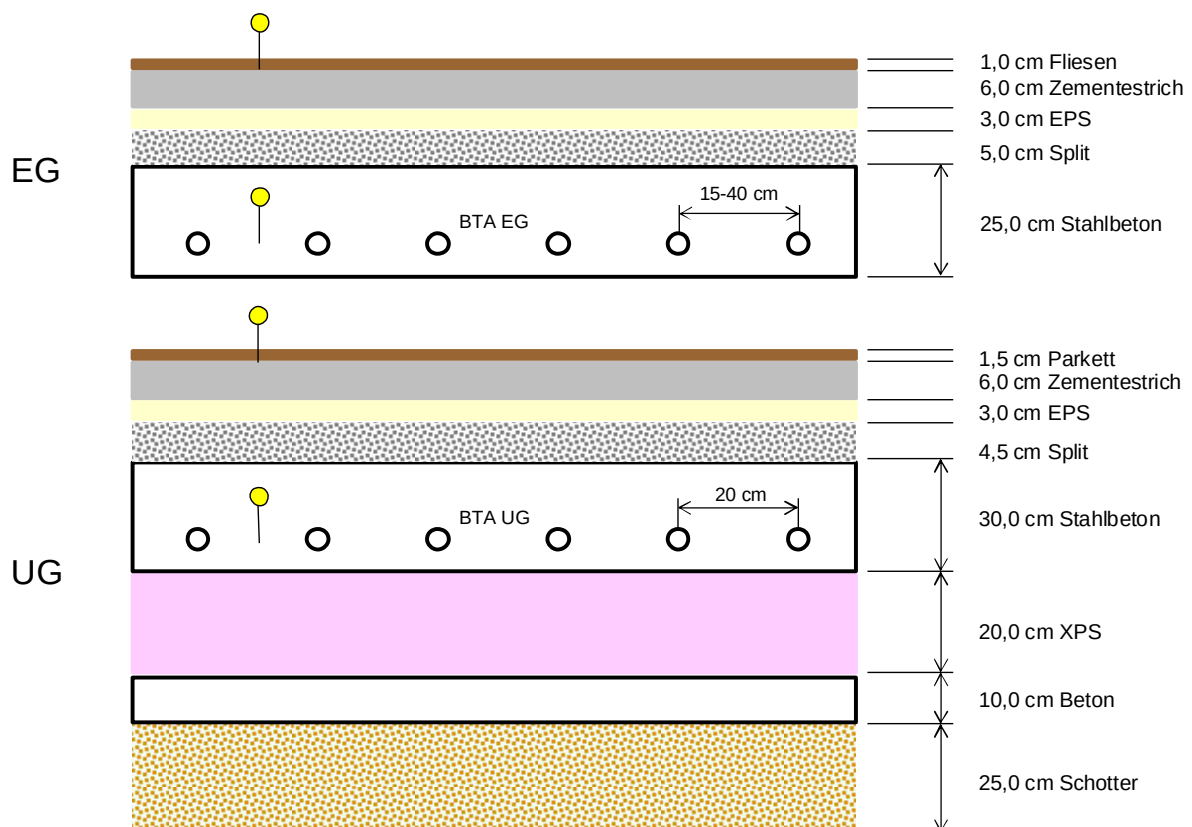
Aufbau des erdanliegenden Fußbodens im Untergeschoss (UG) und der Zwischendecke zwischen Unter- und Erdgeschoss (EG) (Quelle: Einreichplan, eigene Darstellung)
